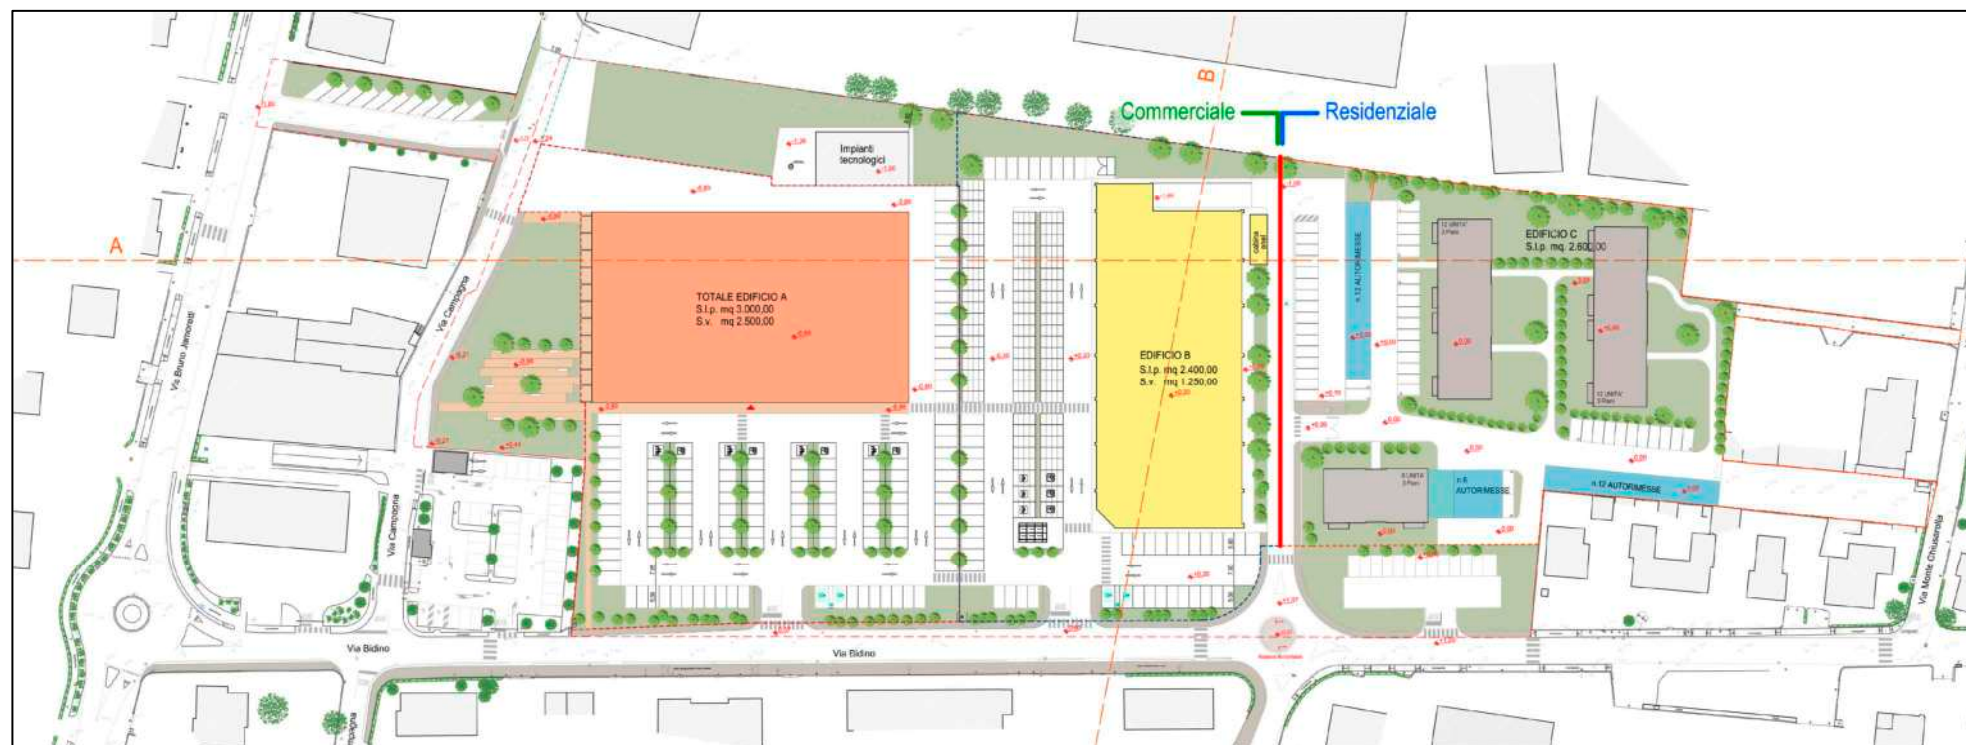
Estratto planimetria generale di progetto.
